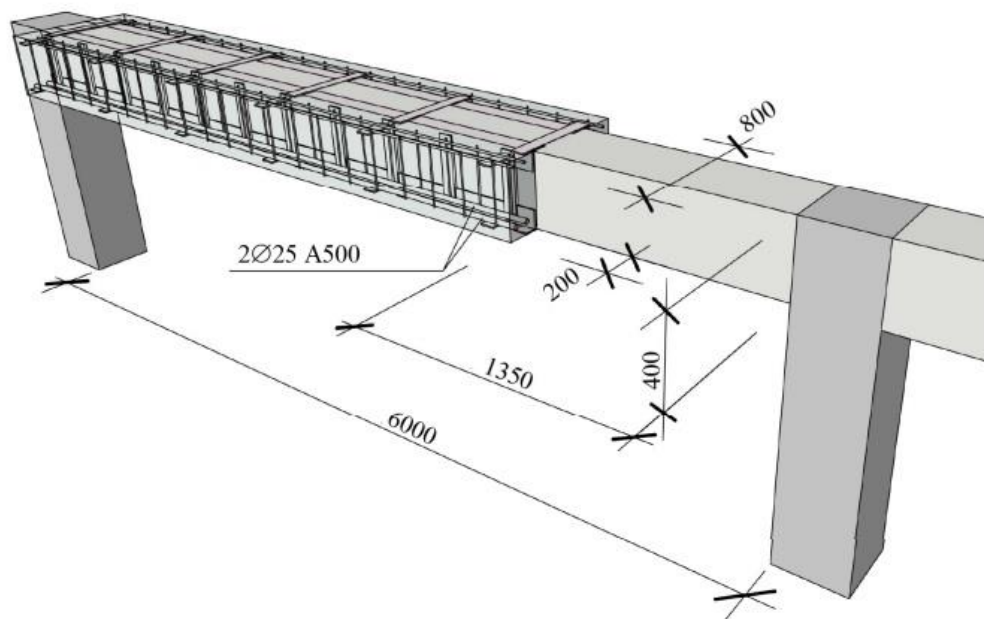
Схема наружного армирования за счет увеличения сечения железобетонной балки
